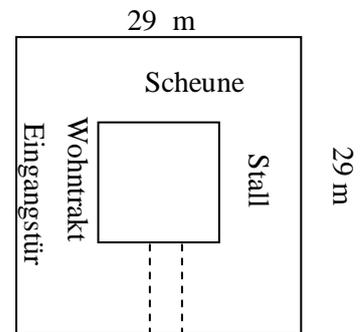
Grundrisssskizze des Vierkanters Preuer in Knillhof
